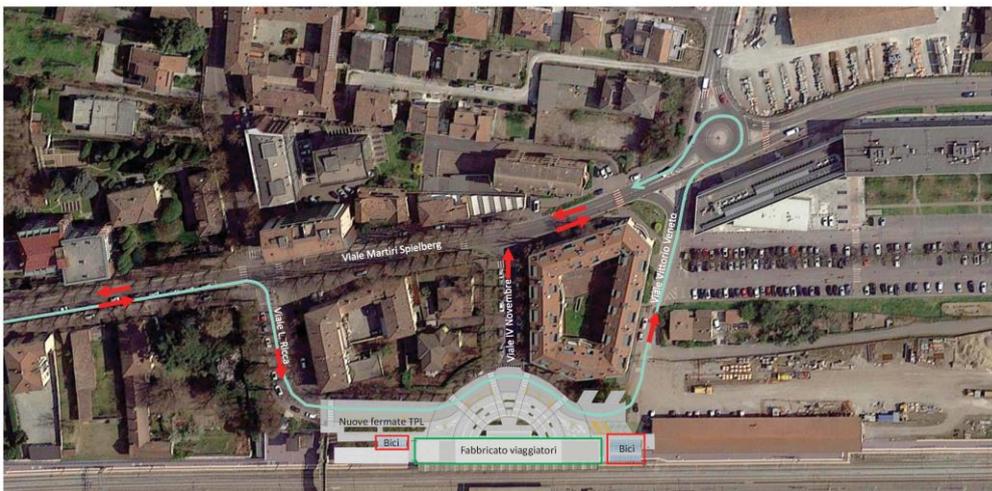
Progetto di riqualifica di Piazza Cadorna: Ipotesi 2 (Fonte: Progetto RFI)
